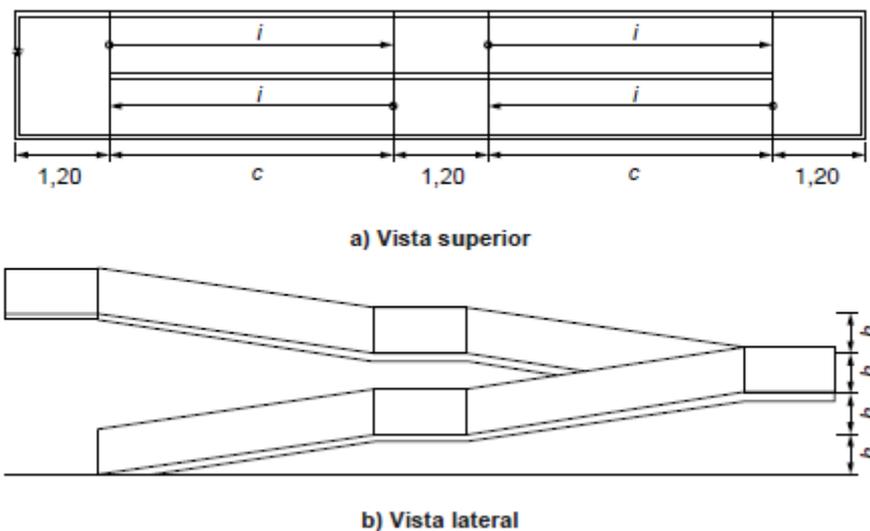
Dimensionamento de rampas acessíveis – Vista de planta e corte.
